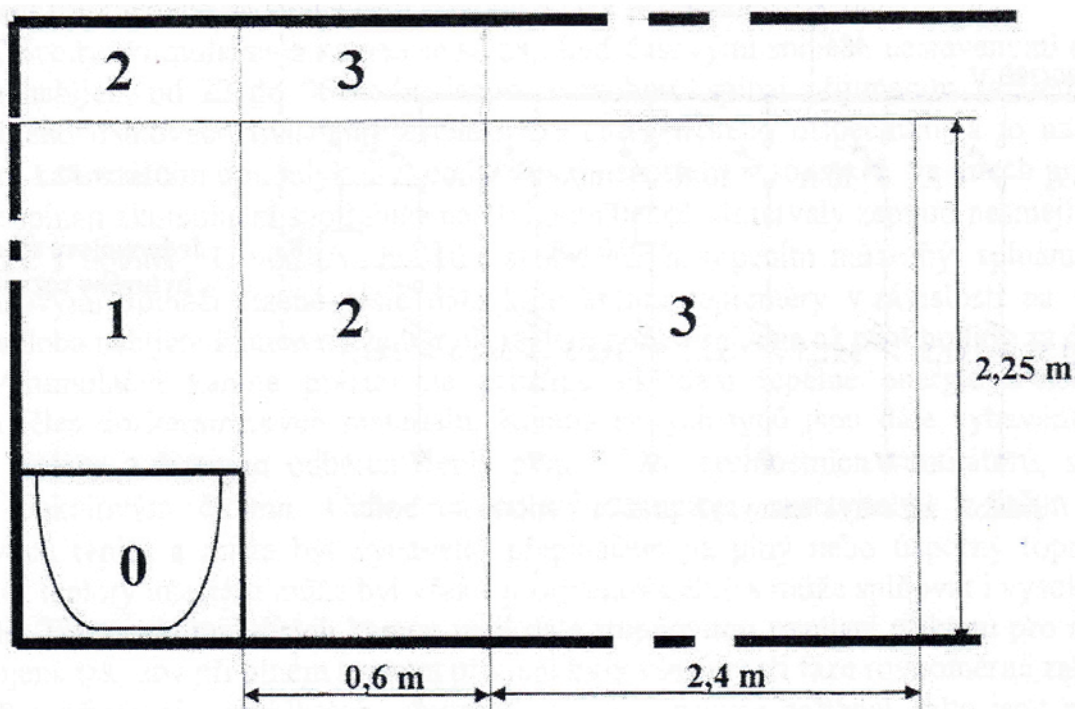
Půdorysné označení koupelnových zón (převzato a upraveno z [1]).
